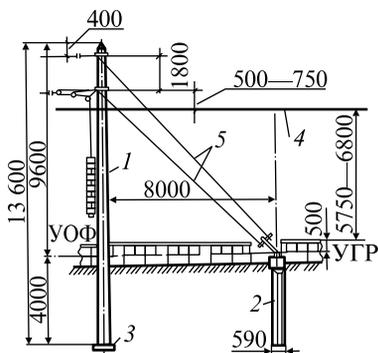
Анкерная железобетонная опора с оттяжками со стойкой длиной 13,6 м: 1 — стойка опоры; 2 — анкер; 3 — опорная плита; 4 — уровень рабочего контактного провода; 5 — оттяжки
